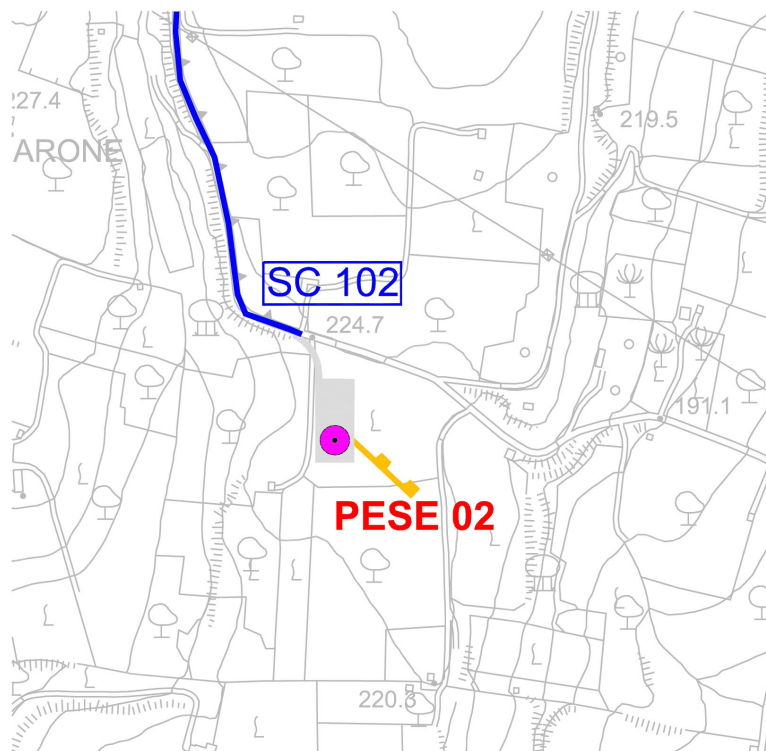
Planimetria delle strade di cantiere scala 1:5.000
